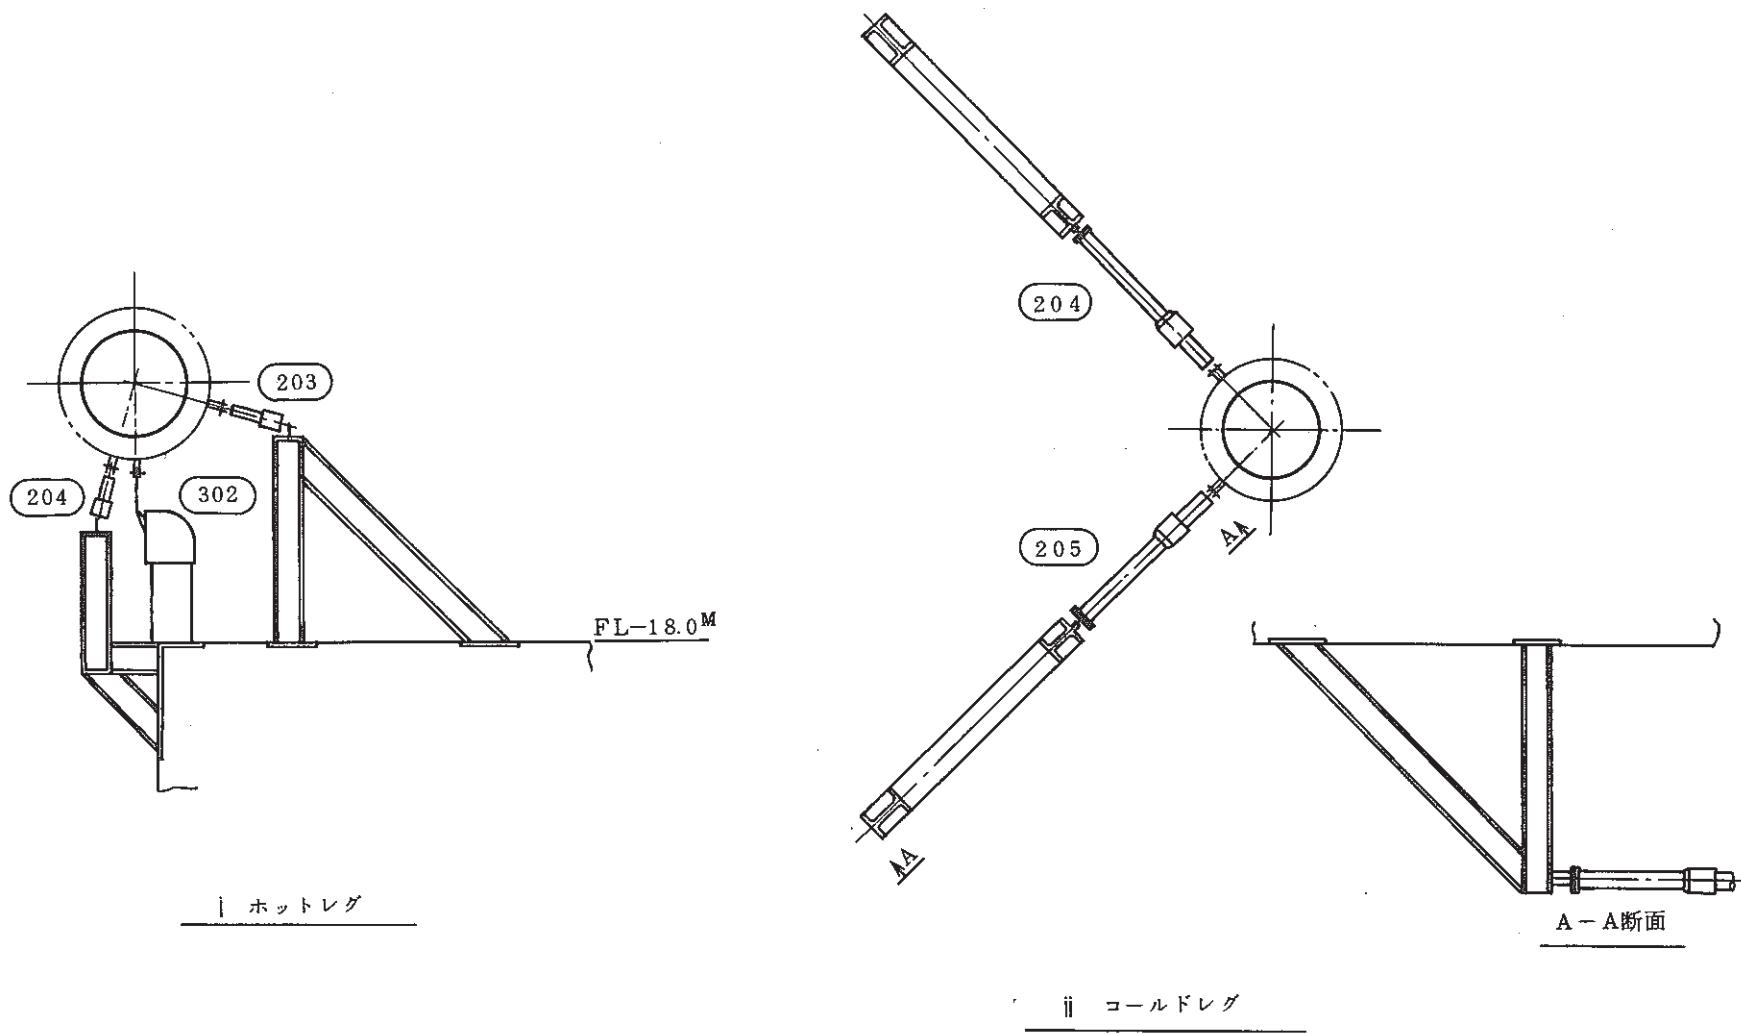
1次主冷却機器配管配置図（立面図）
